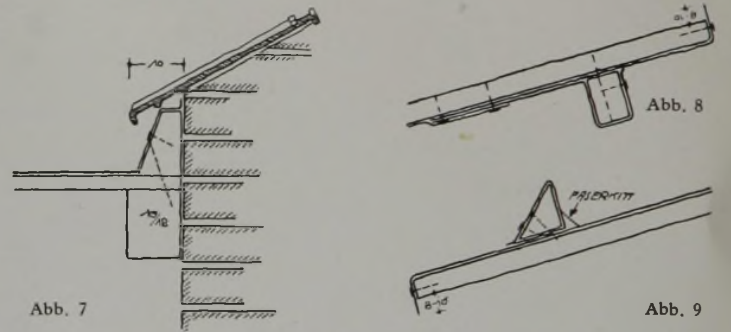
Anschluß eines Falzziegeldaches an ein Pappdach. Dichtung ohne Metall auf Anschlußleiste mit schrägem Längsschnitt. Einfache handwerkliche Ausführung mit sicherer Dichtung.
